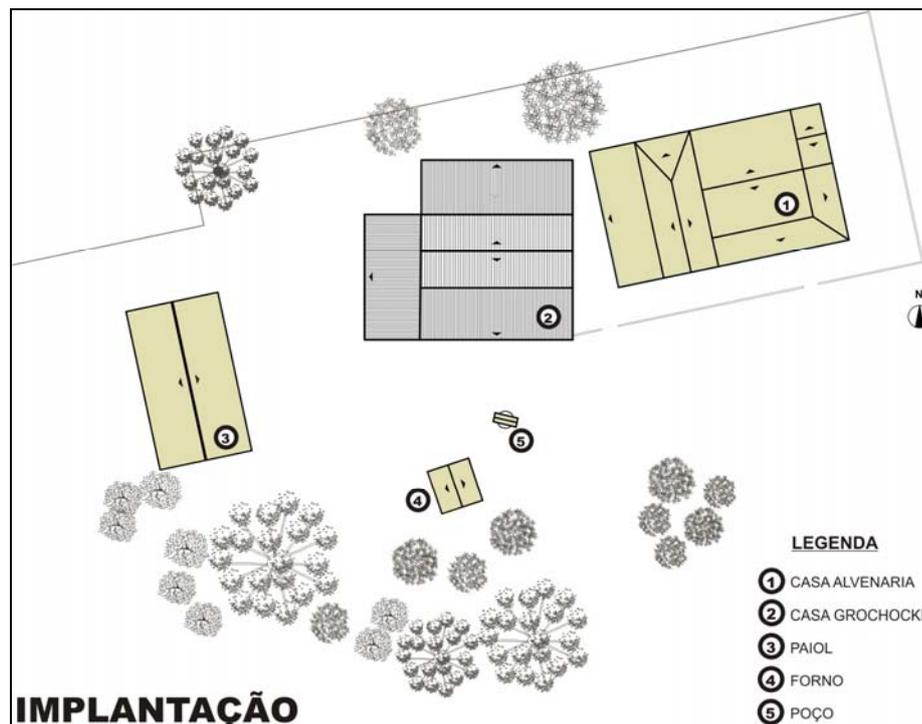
LEVANTAMENTO ARQUITETÔNICO – IMPLANTAÇÃO
